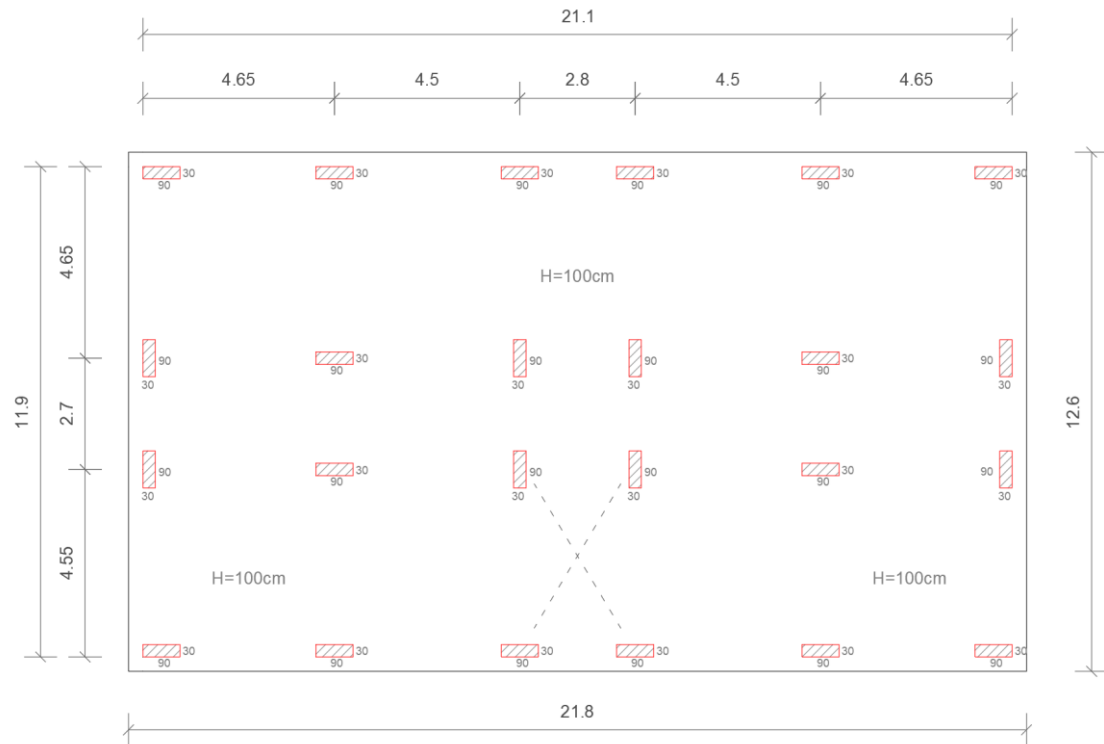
Carpenteria struttura in c.a. a tre piani con platea di fondazione.
